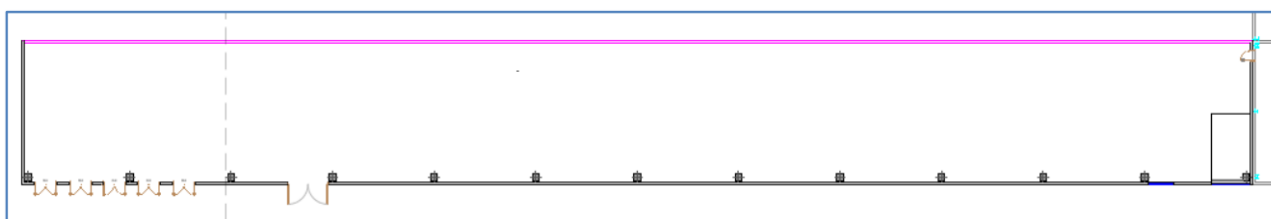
Detalle forjado sobre muelles recepciones escenario automático Fuente Elaboración propia
